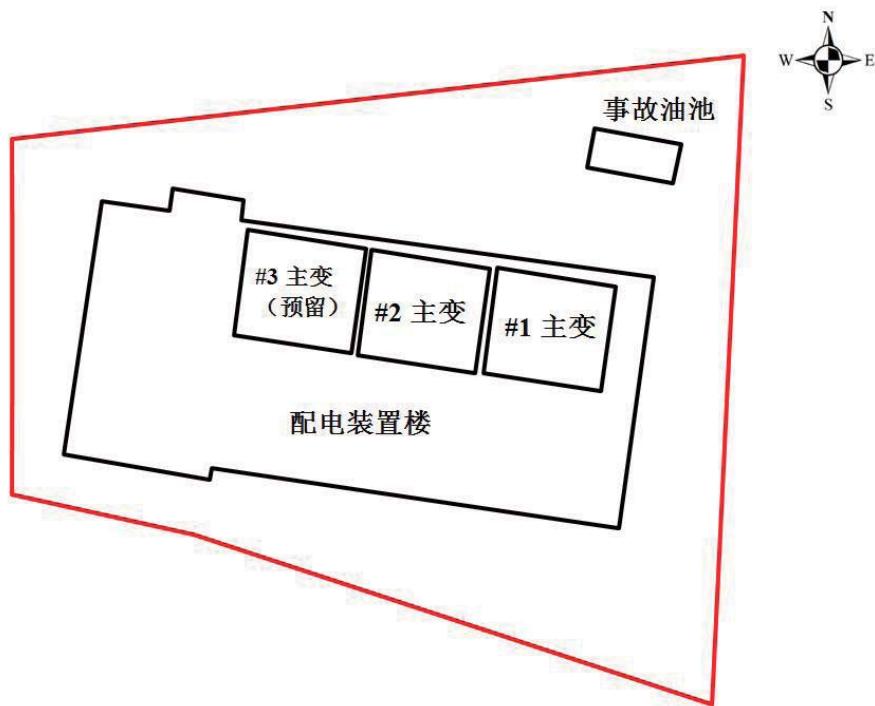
广州 110 千伏裕丰变电站总平面布置示意图
